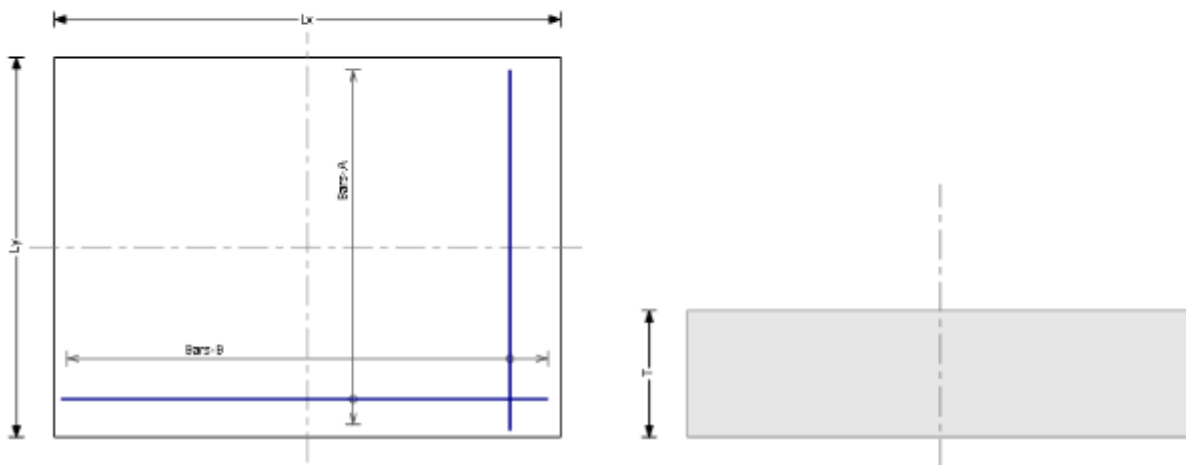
Planta y elevación la losa de cimentación, análisis lineal
